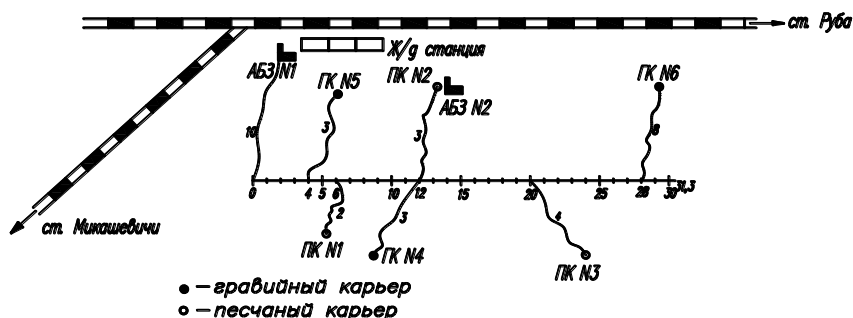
План-схема вариантов размещения АБЗ
